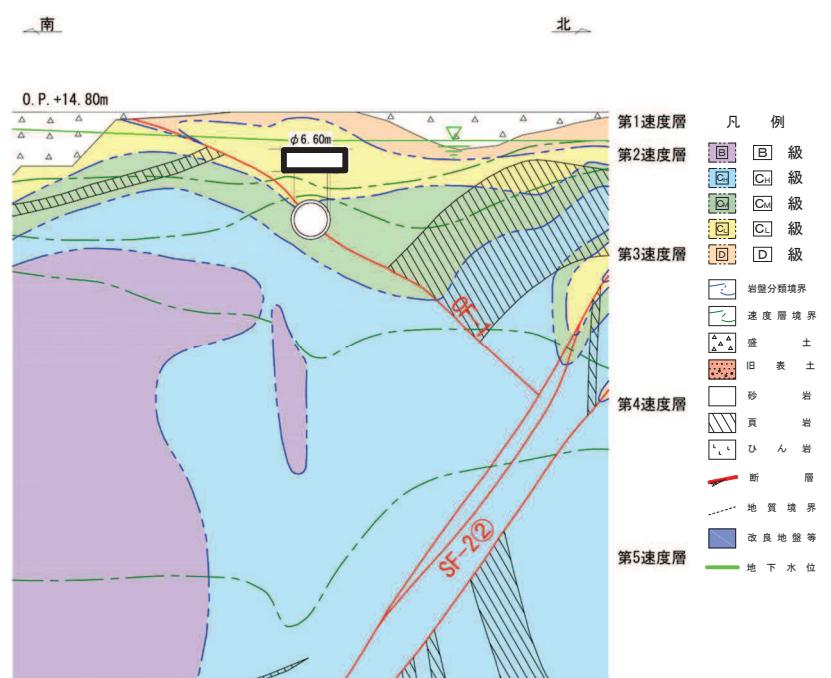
排気筒連絡ダクト（岩盤部）評価対象断面図（断面⑦）
